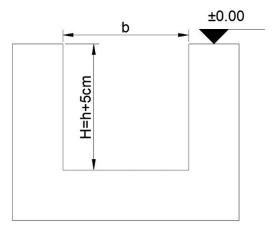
基坑排水沟示意图 基坑排水沟单位工程量表
